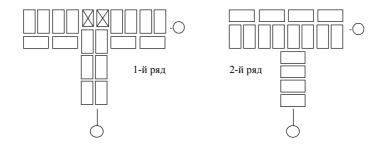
Кладка примыканий стен толщиной в 1,5 и 1 кирпич
